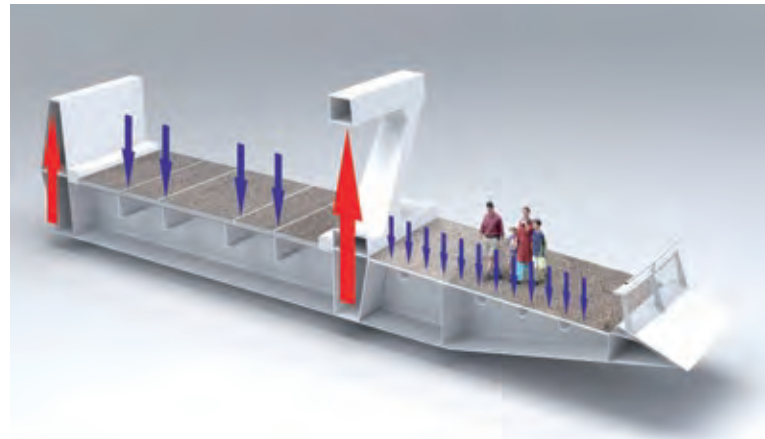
Gleichgewicht zwischen Einwirkungen und Längsträgerkräften in Brückenquerrichtung
